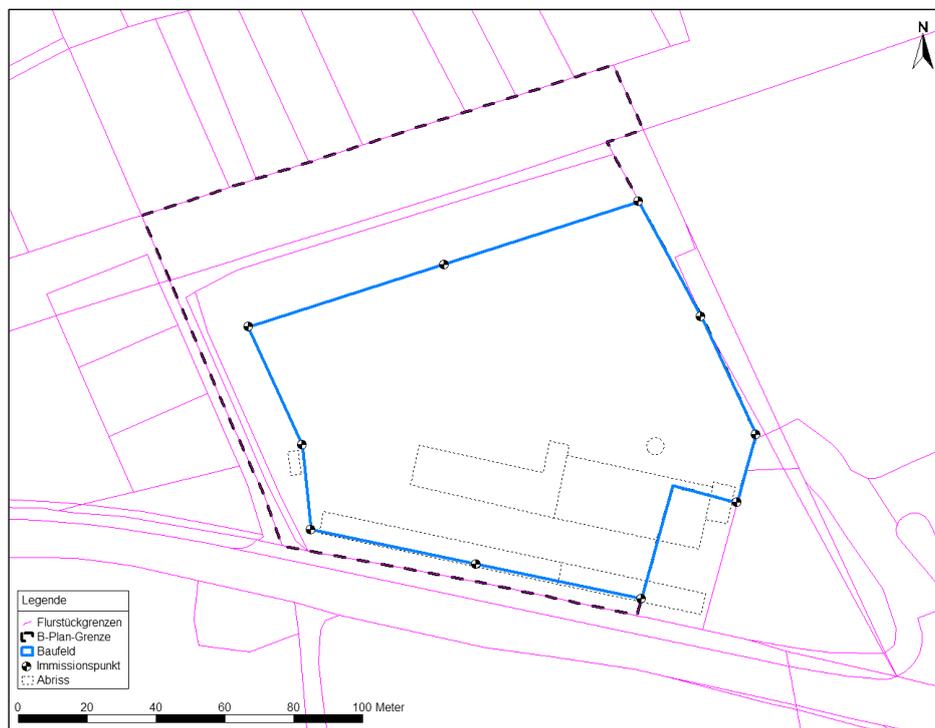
Rechenmodell-Lageplan mit Plangebiet, Baufeld und Immissionspunkten
